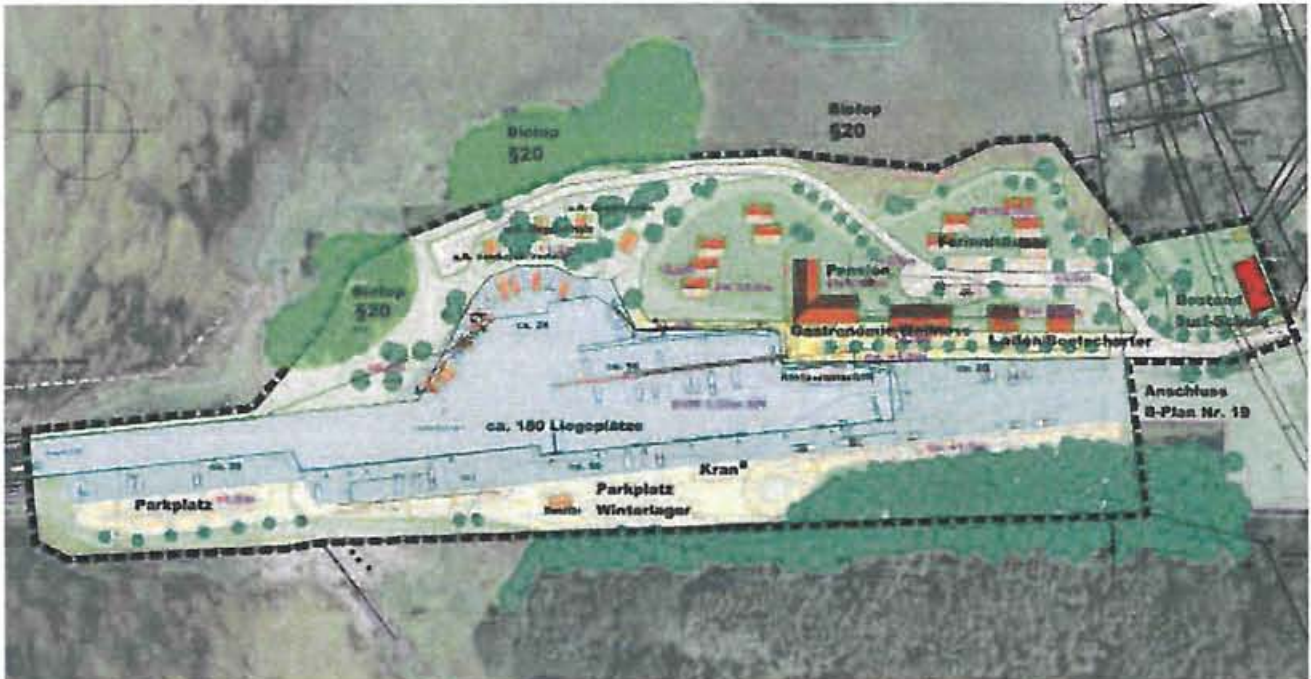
städtebaulicher Lageplan, Stand November 2016 (ohne Maßstab)
